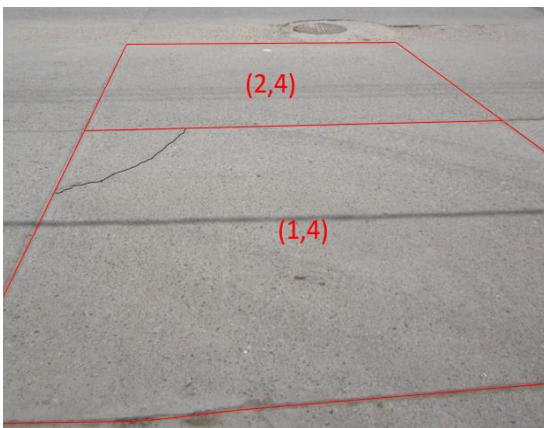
Grietas en bloque de severidad baja en Losa (4,2) de la unidad de muestra T2 – U04. Fecha: 10/03/2017.
